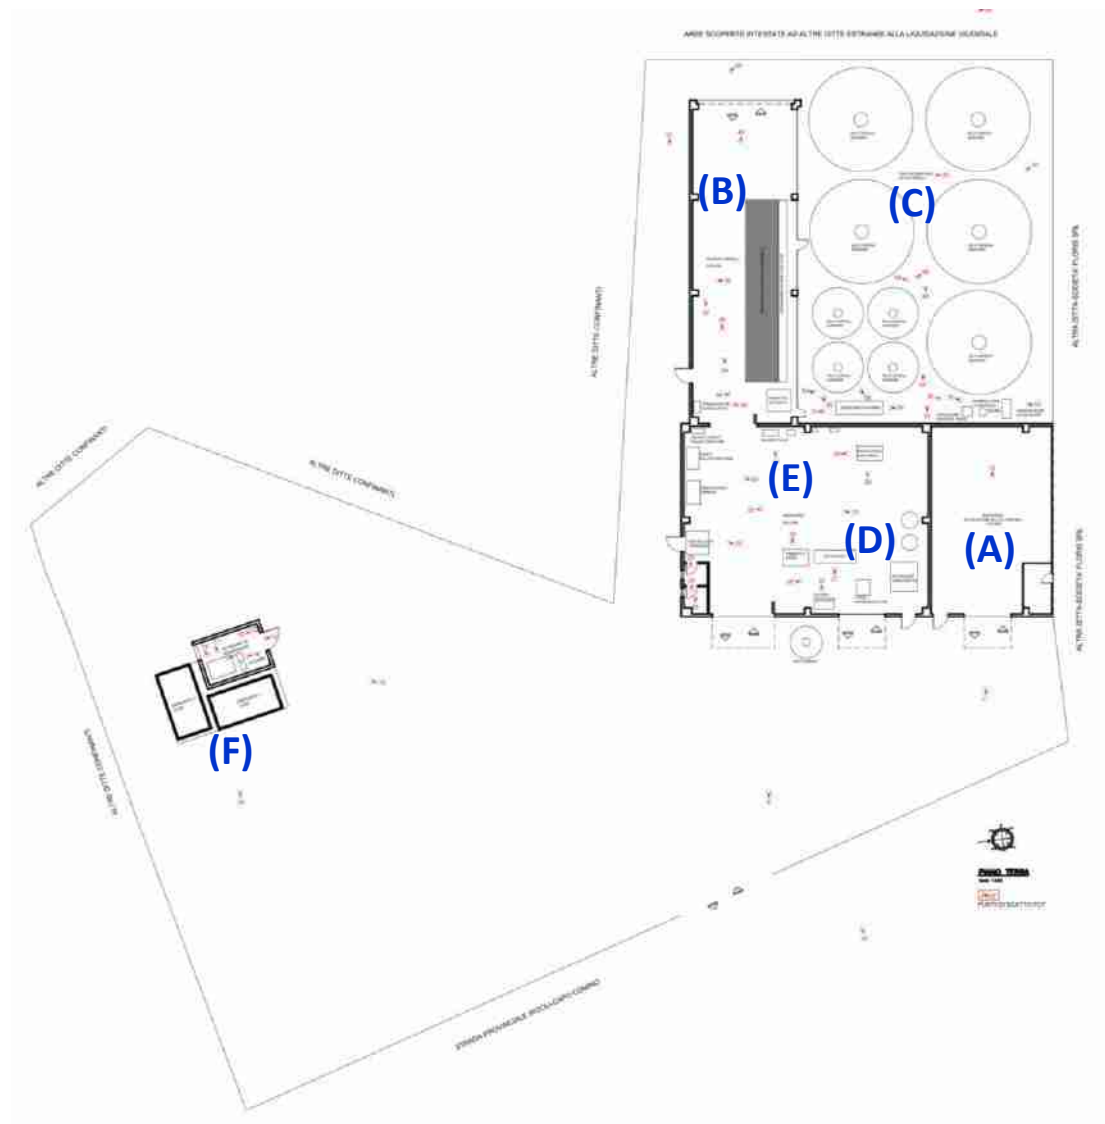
\_Planimetria generale del [redacted] n. 36 p.la 2041 sub.1+2+3
